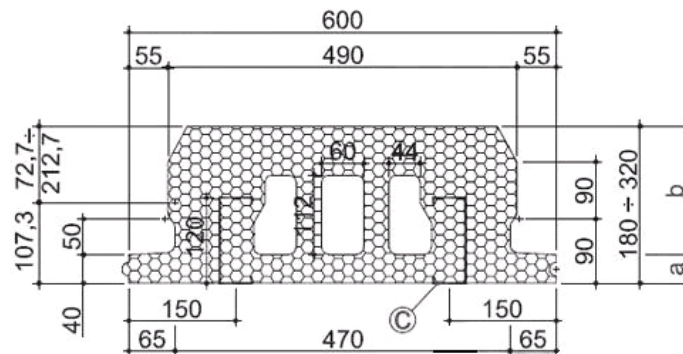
Поперечний переріз незнімної опалубки PLASTBAU (ПЛАСТБАУ) для міжповерхових перекриттів і настилу даху.
